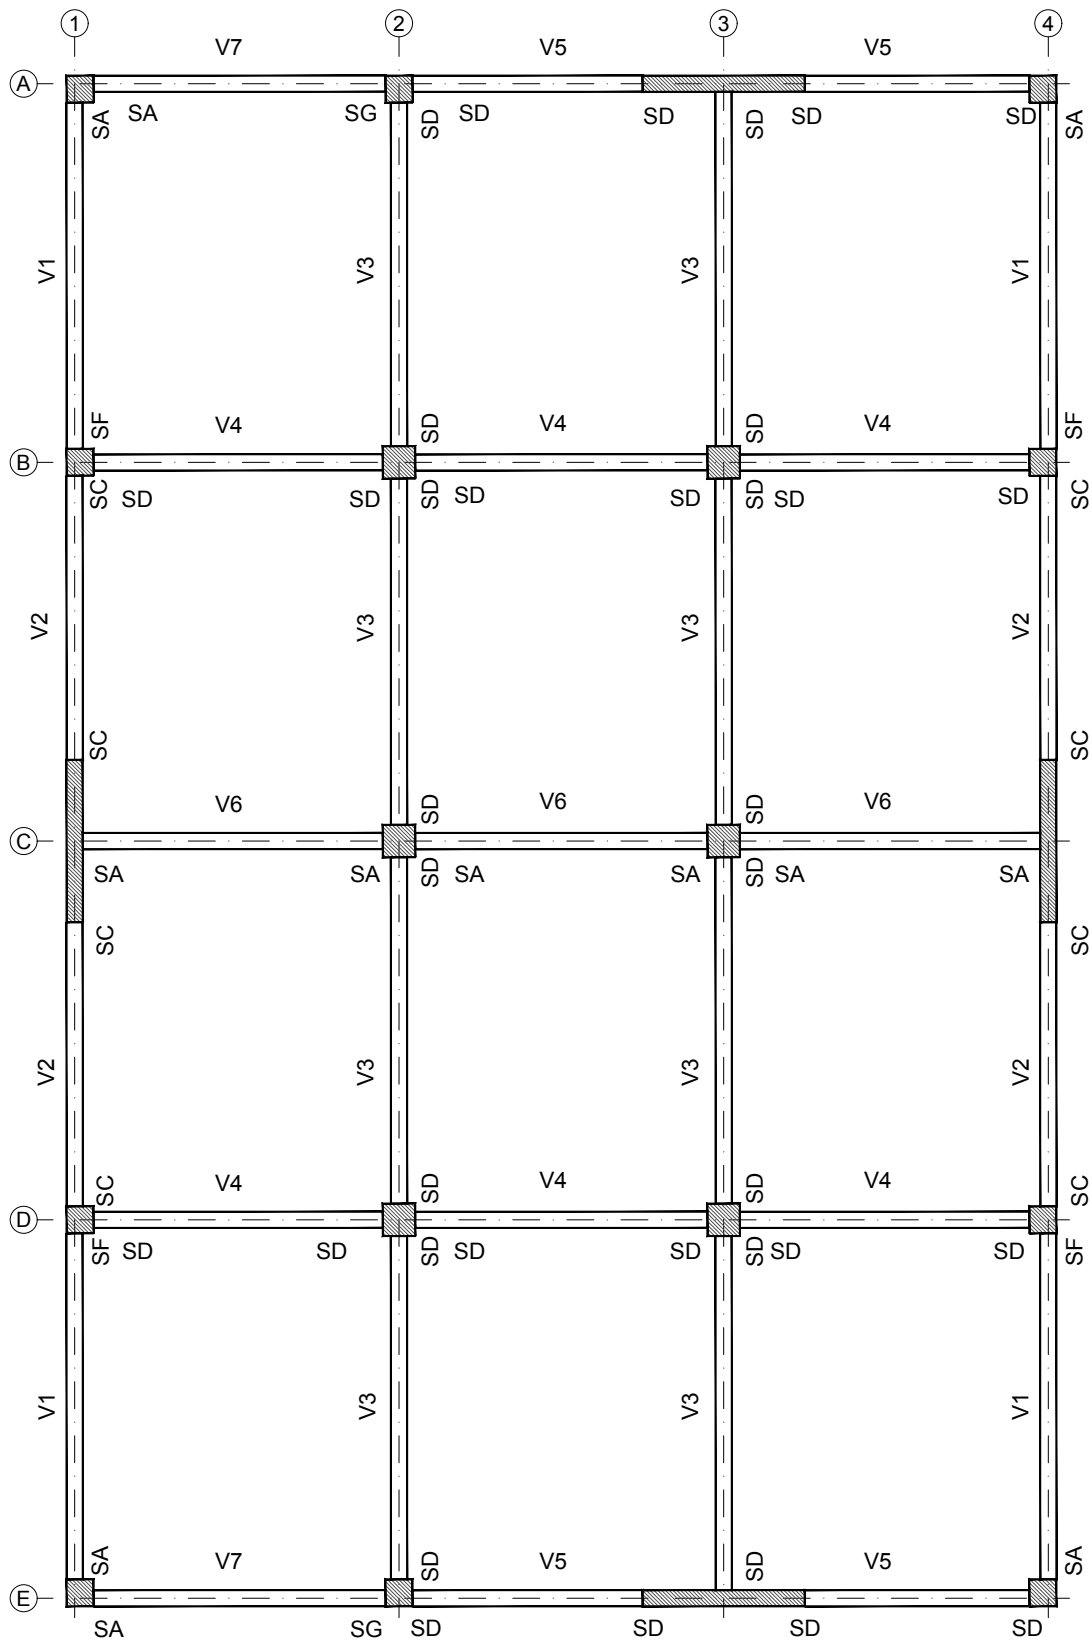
Vigas e secções de armadura das vigas – Piso 1.
